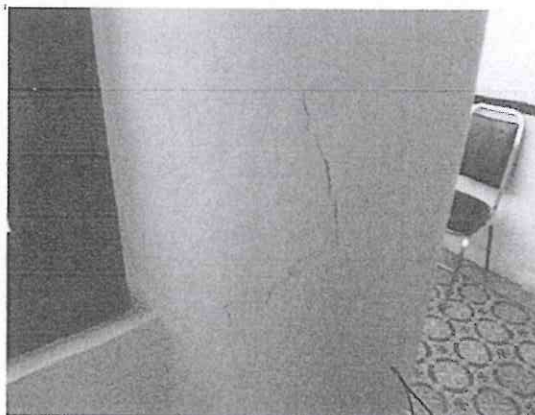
Fisura en el aplanado de una columna, misma que no representa riesgo estructural, sin embargo se recomienda su sellado.
